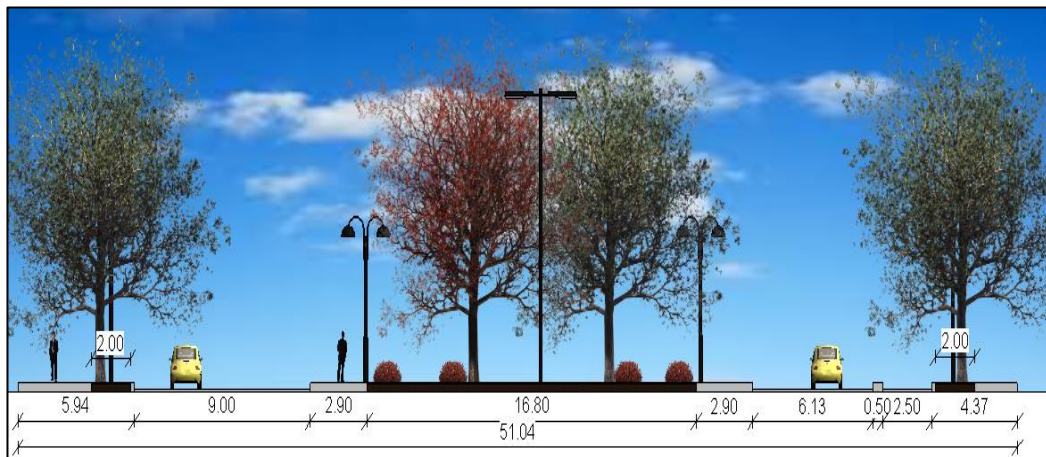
Sección transversal de Avenida Fray Vicente Solano, Carolina Chérrez Sacoto.
